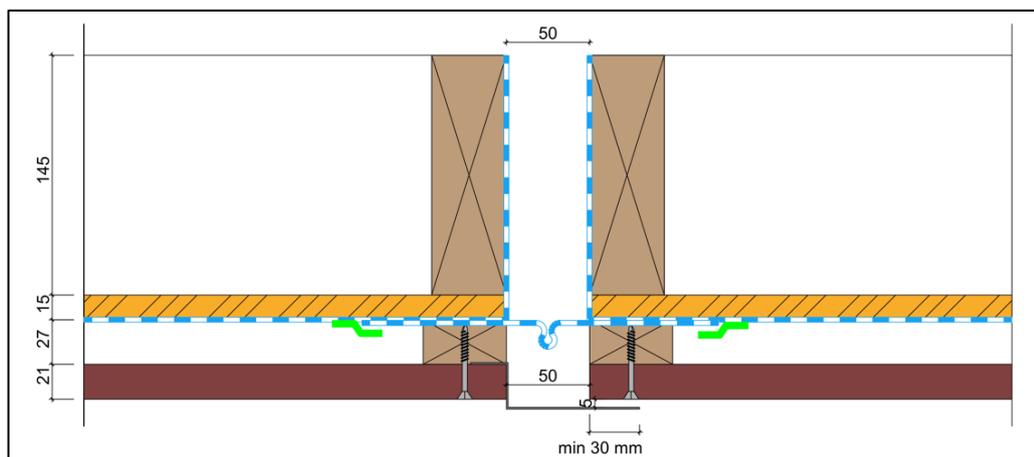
Coupe horizontale maquette croix de jonction – bardage bois
